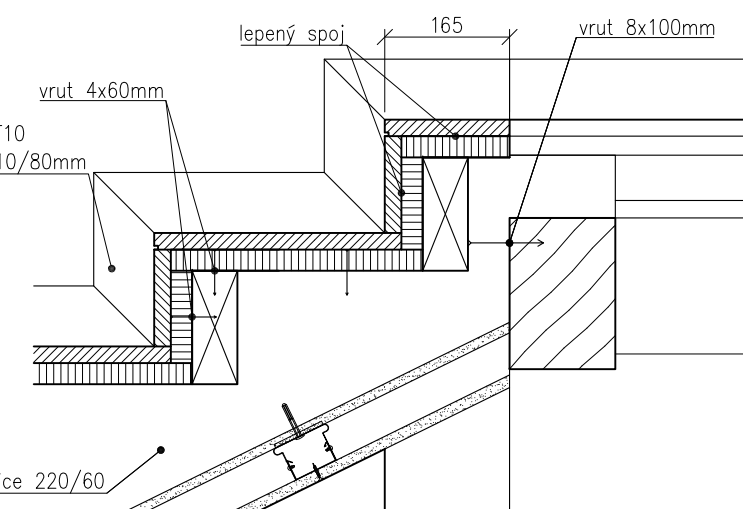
DETAIL NAPOJENÍ NA MEZIPODESTU M1:10
